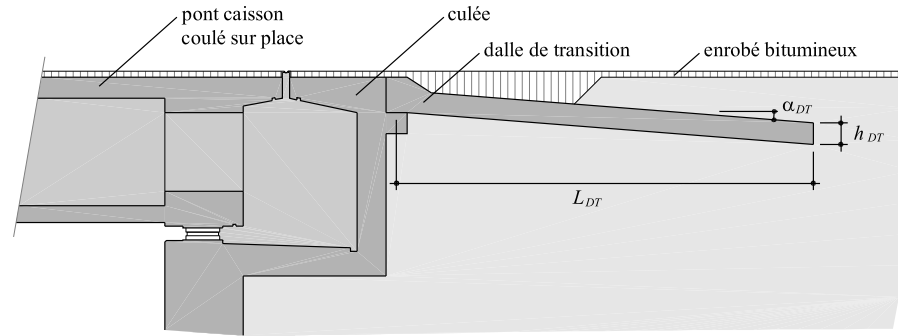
Détail standard d'une dalle de transition d'un pont suisse avec joints [OFROU 2010]
